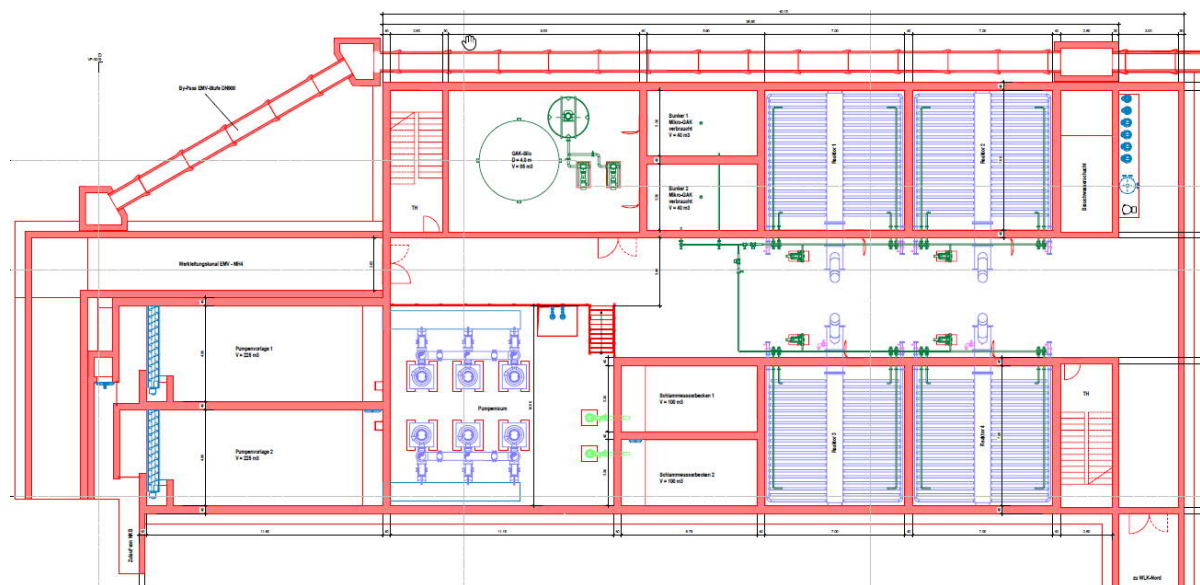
Ausschnitt Grundriss UG
